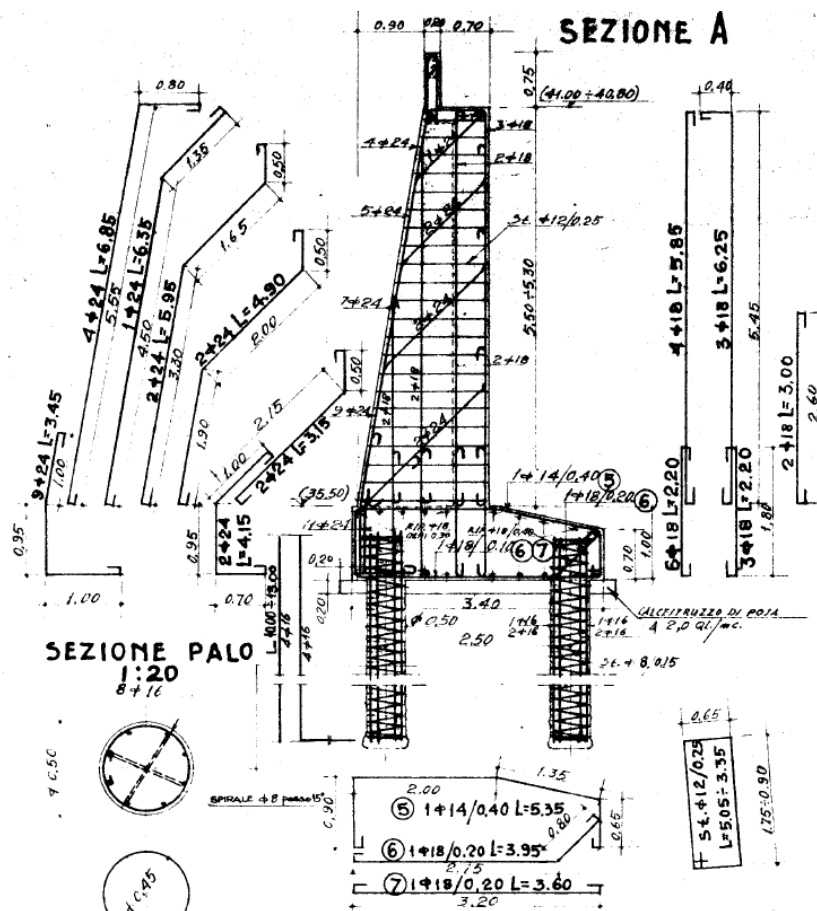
Documento as-built “Sottovia via Zanardi al km 10+793,18” – Sezione trasversale con armature contrafforti
